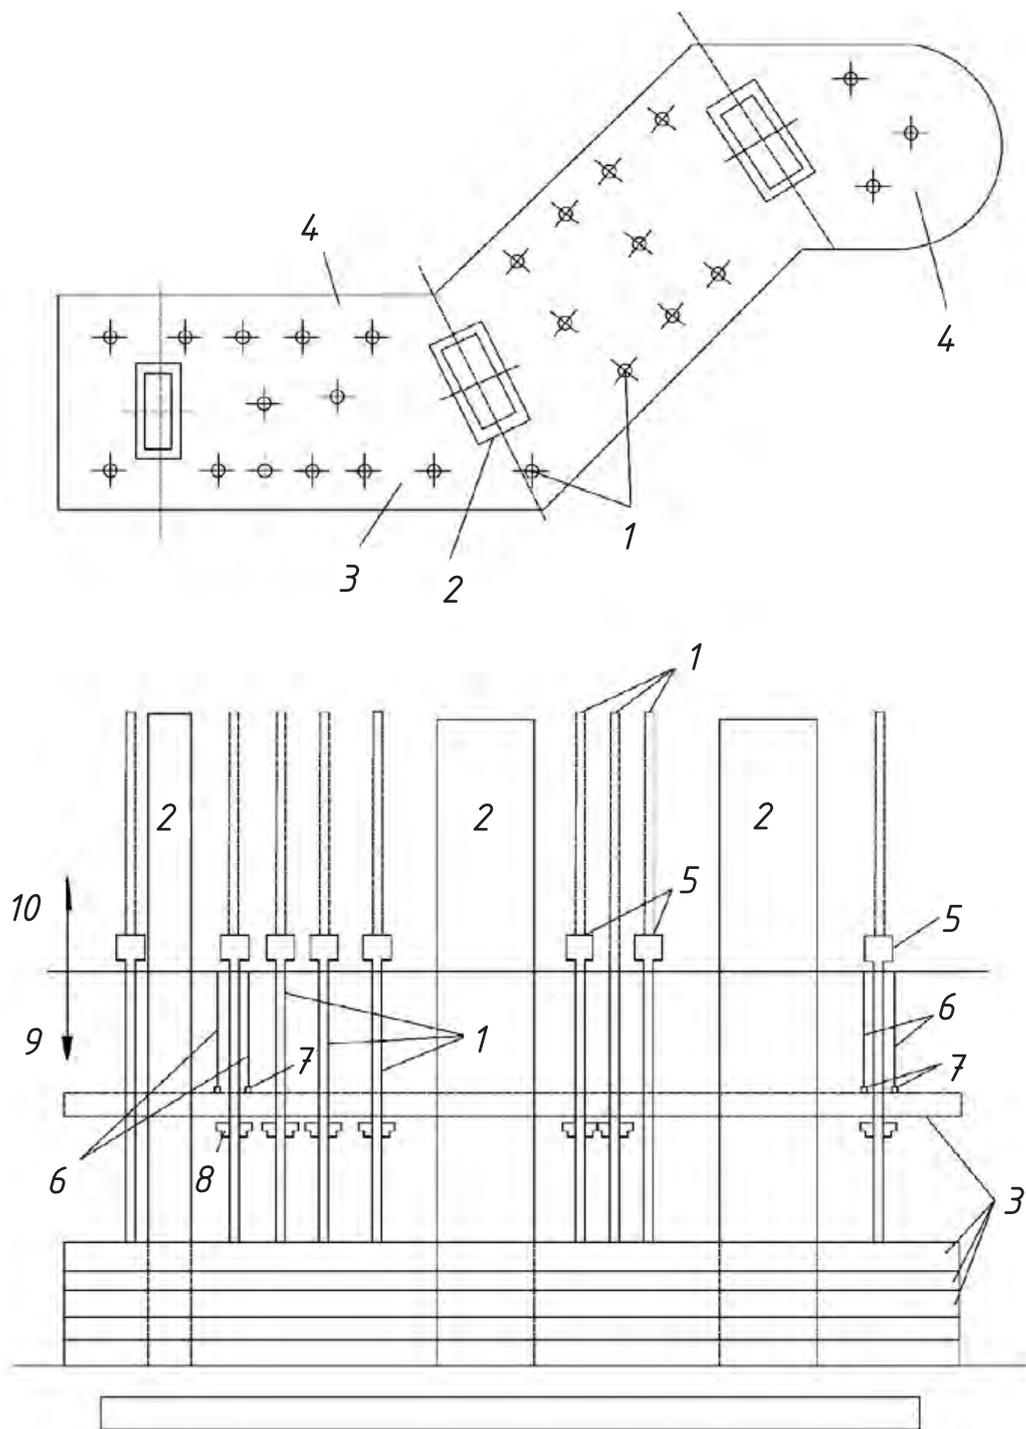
Схема метода подъема перекрытий: 1 — колонны; 2 — ядро жесткости; 3 — перекрытия; 4 — консоли перекрытий; 5 — домкраты; 6 — тяги; 7 — закрепление тяг к перекрытию; 8 — монтажные или временные опоры; 9 — 1-я захватка; 10 — 2-я захватка
